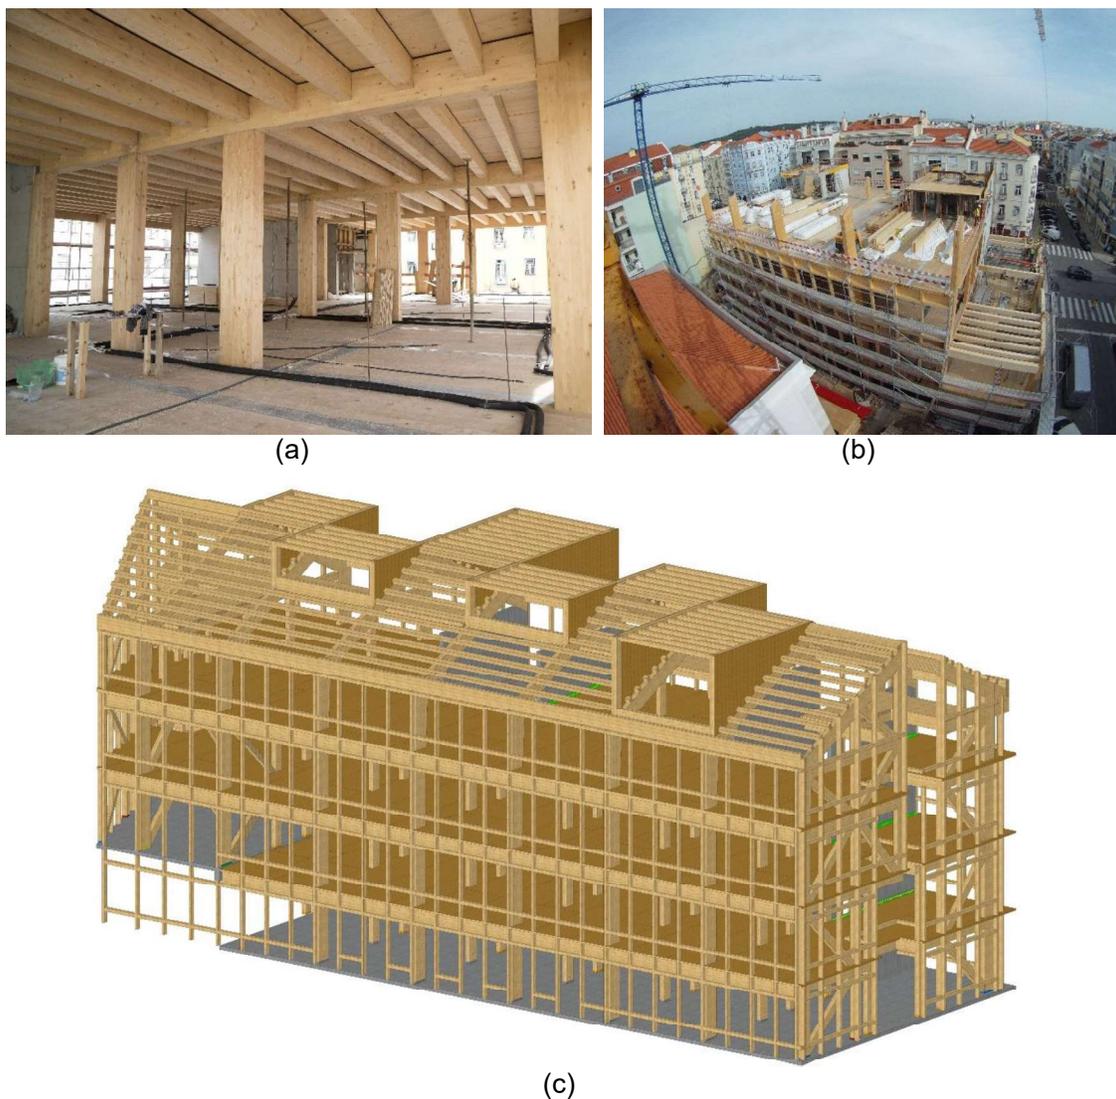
Redbridge School: a) e b) fotos da execução; e c) perspetiva da modelação do edifício em CLT
